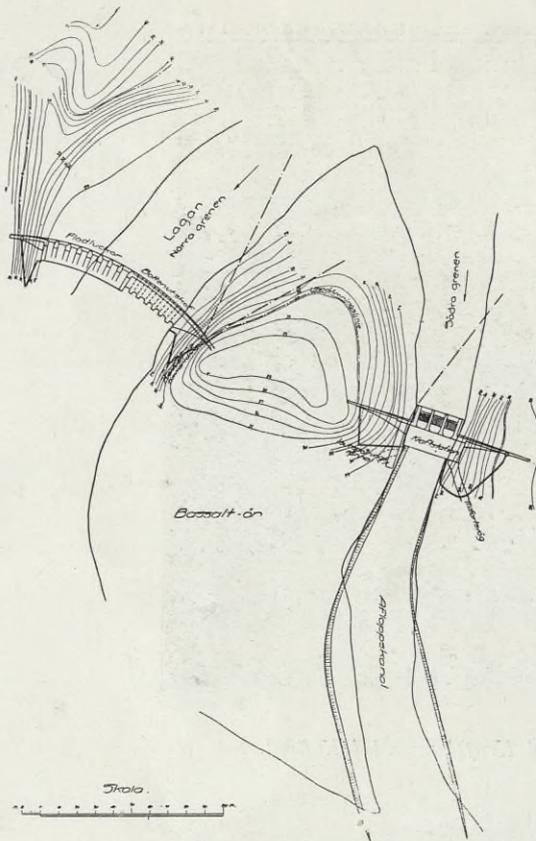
Lagan. Lageplan der Anlage bei Bassalt.
